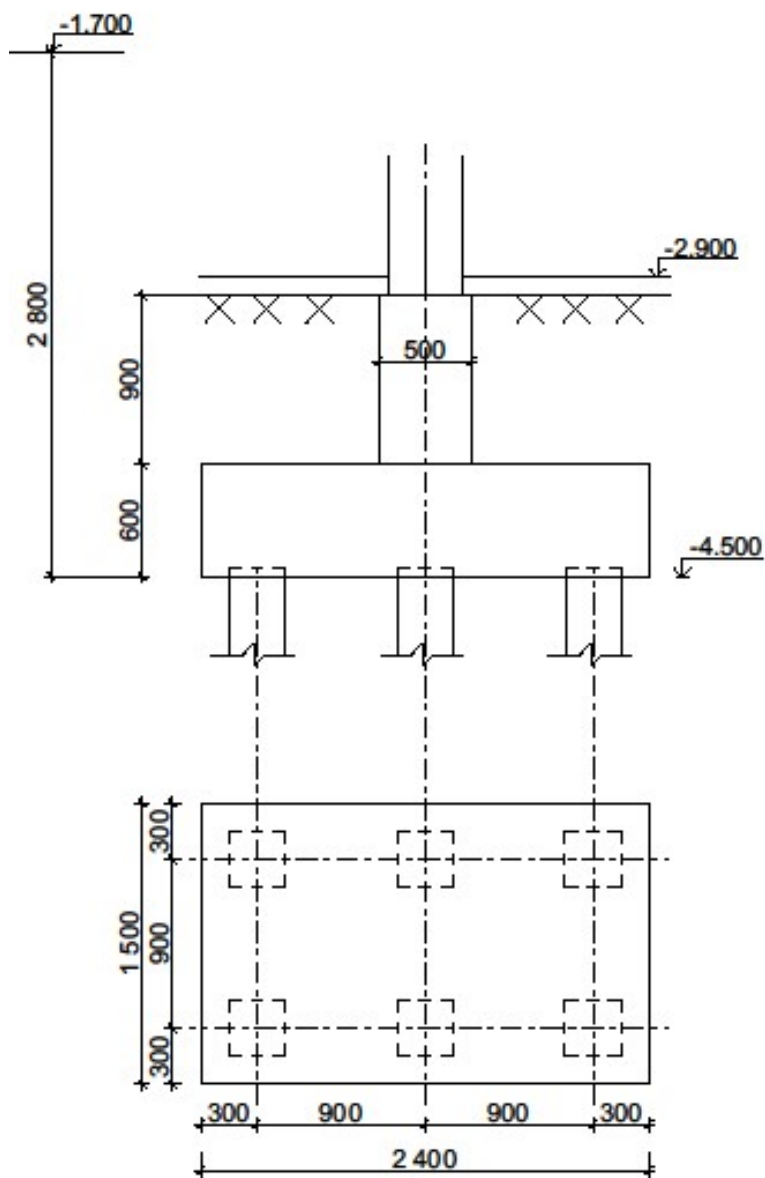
Конструктивне рішення ростверку пального фундаменту під монолітну залізобетонну колону
